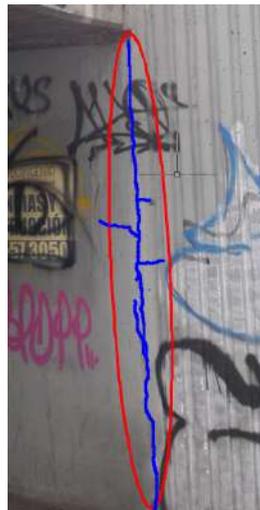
Box Coulvert peatonal, presencia de fisuras
